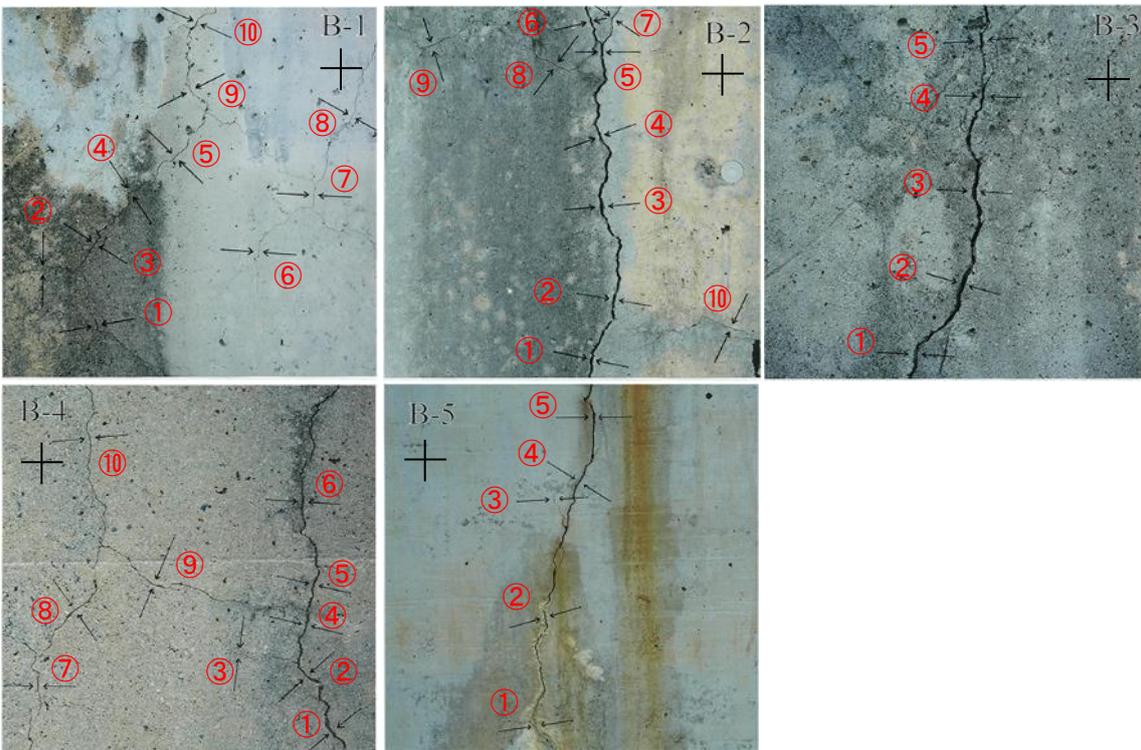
グループ B : 錆汁等表面の汚れが目立つコンクリートのひびわれ
